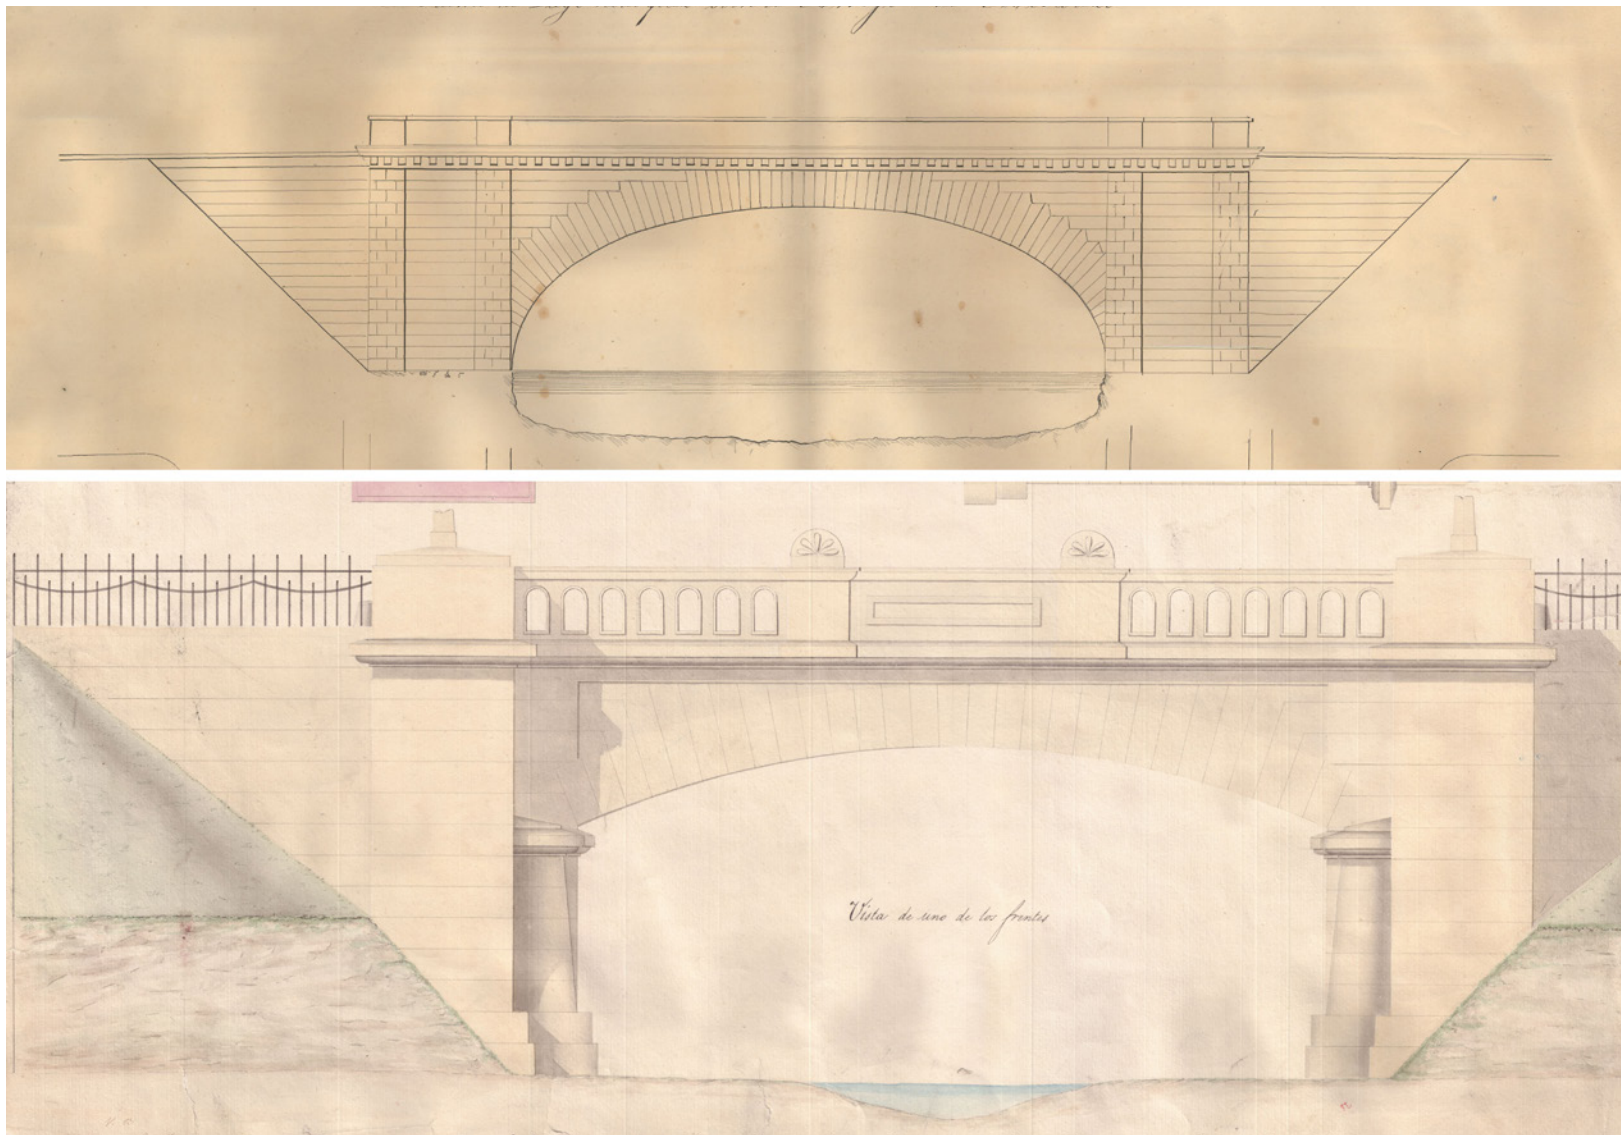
Arriba: Puente de Diego Velazquez, Francisco de Albear, 1848, AGMM, CUB-41/13; Abajo: Vistas y perfiles del puente construido sobre el Arroyo Ponton en la Calzada de la Ynfanta D.ª. Maria Luisa Fernanda, Juan María Muñoz, 1843, AGMM, Cartoteca, CUB-174/3
